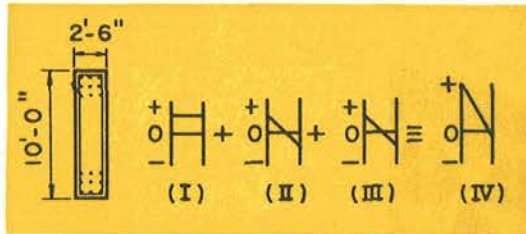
Punto de Tasman. Sección transversal y diagrama típico de tensiones para soportes de 130 pies (39,62 m) de altura.
